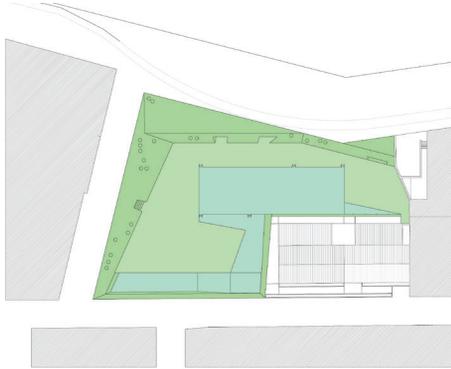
Plano de cubierta del *Valle Artificial*, Lobres.
